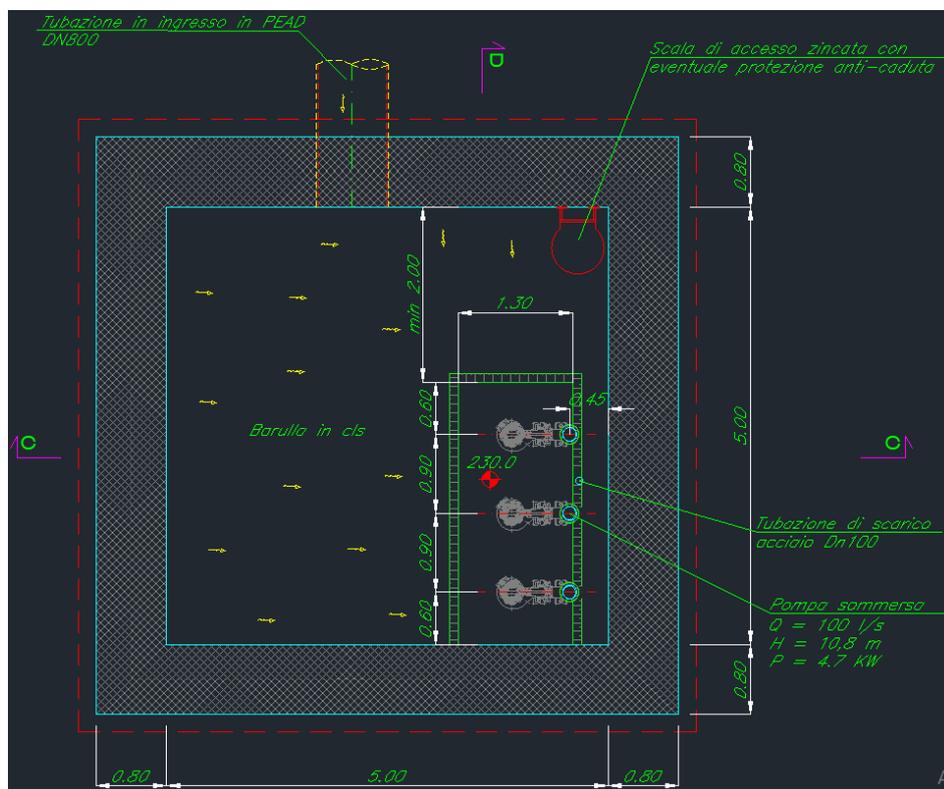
Configurazione planimetrica dell'impianto di sollevamento
